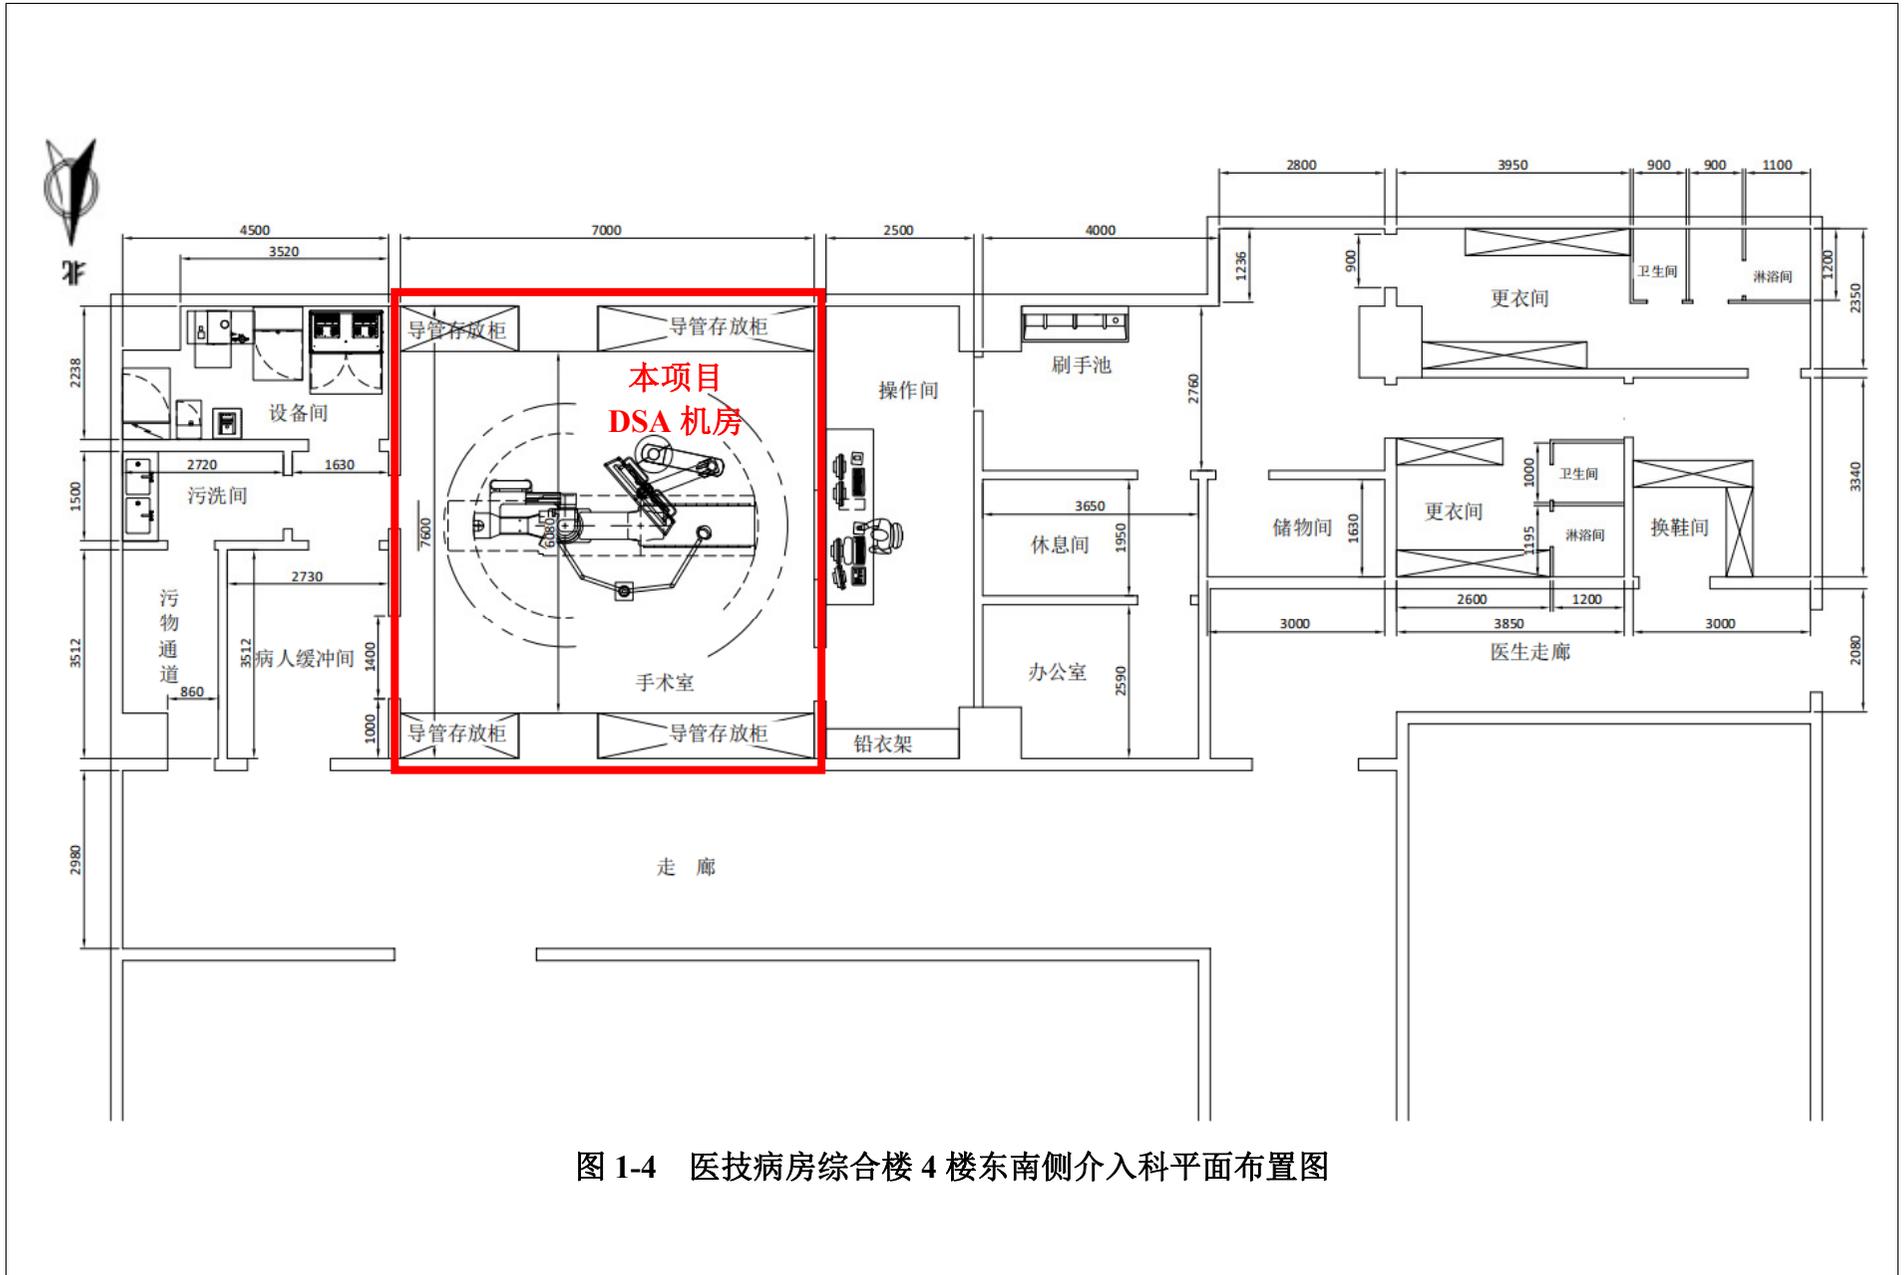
医技病房综合楼 4 楼东南侧介入科平面布置图
